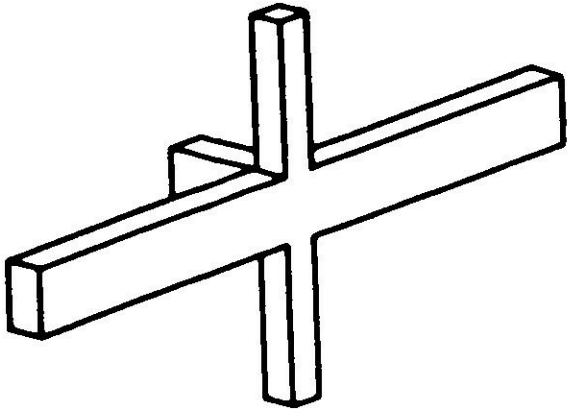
Encuentro de pilar con vigas internas y laterales.
